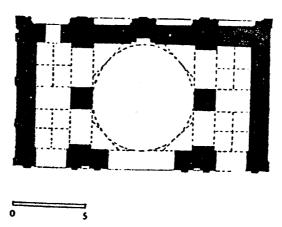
مسقط أفقي لمجمع (كلية) السلطان بايزيد بأدرنه (عن: Goodwin).
